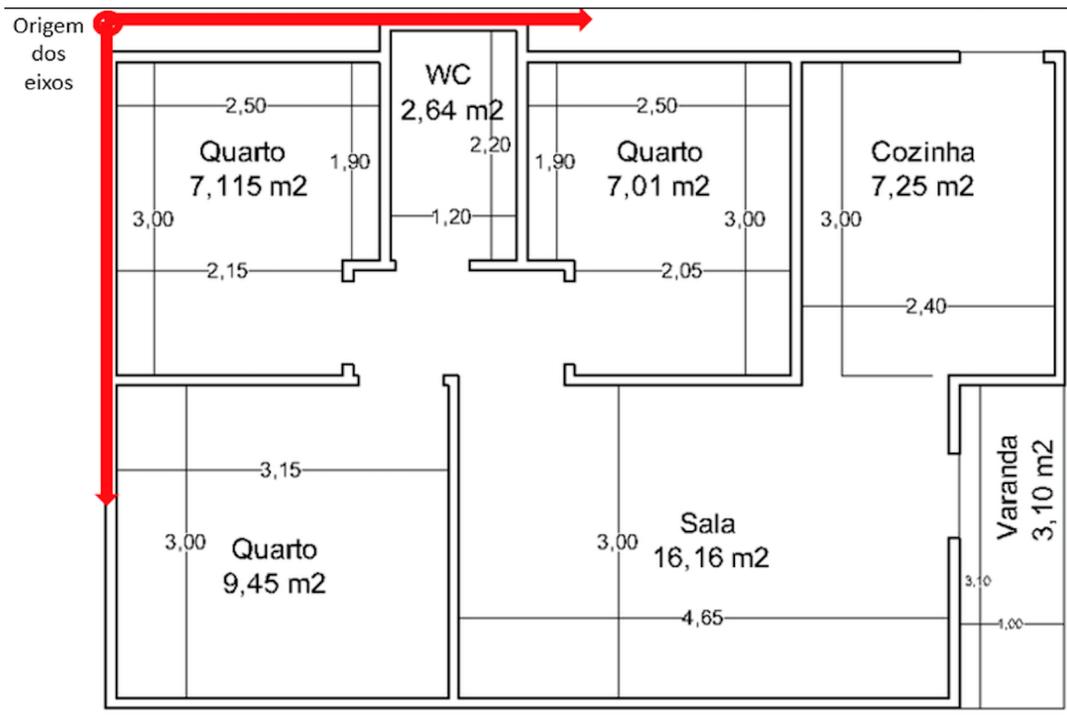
Planta baixa dentro do Substrato Espacial do Paper.js
